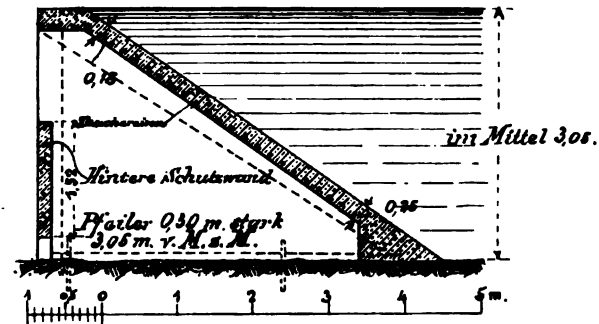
Überfallwehr bei der Stadt Fenelon Falls, Ontario.
